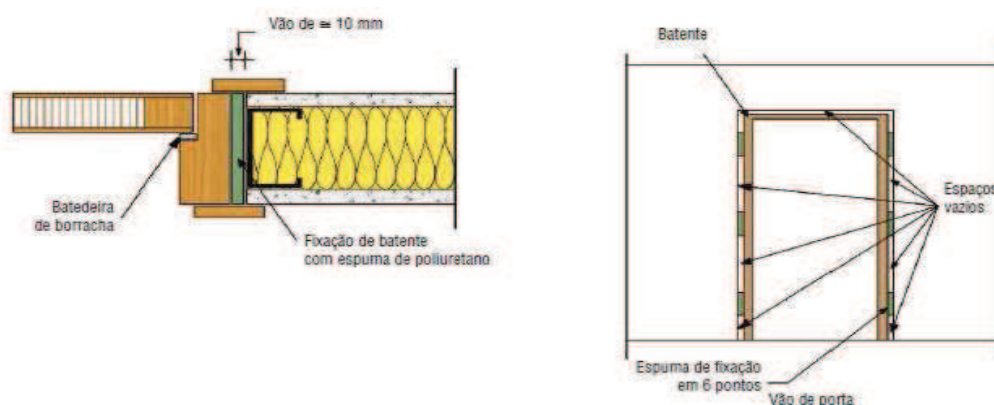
Detalhe para fixação de portas em estruturas de LSF.
